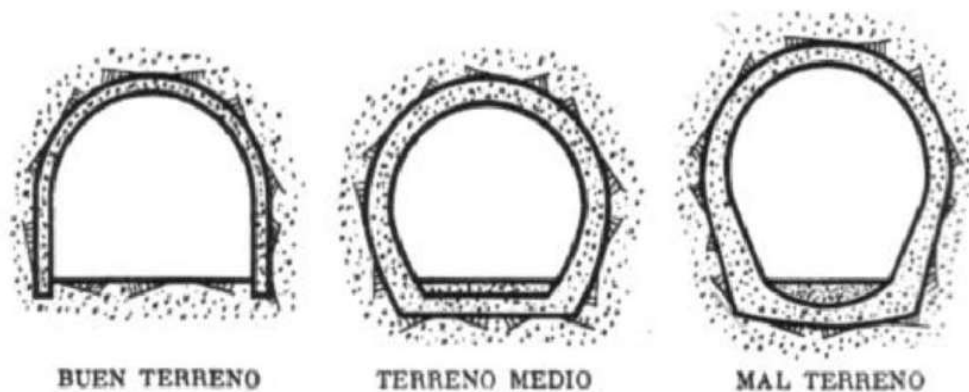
Secciones transversales de túneles para vías férreas
